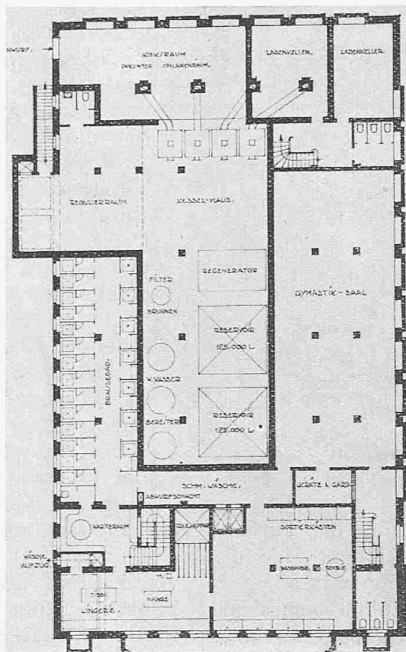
und 2. Grundrisse vom Unter- und Erdgeschoss. — Masstab 1 : 500.
